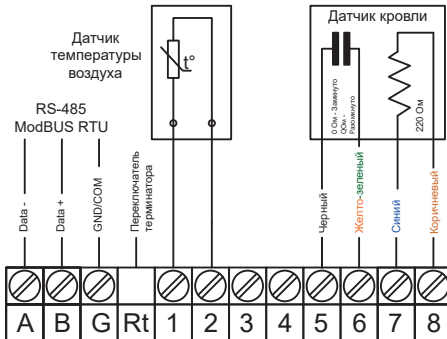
Схема подключения датчика кровли Ридан Roof 850RG
